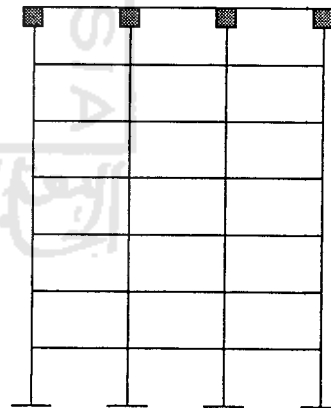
Tingkat 7 lantai ke 4
